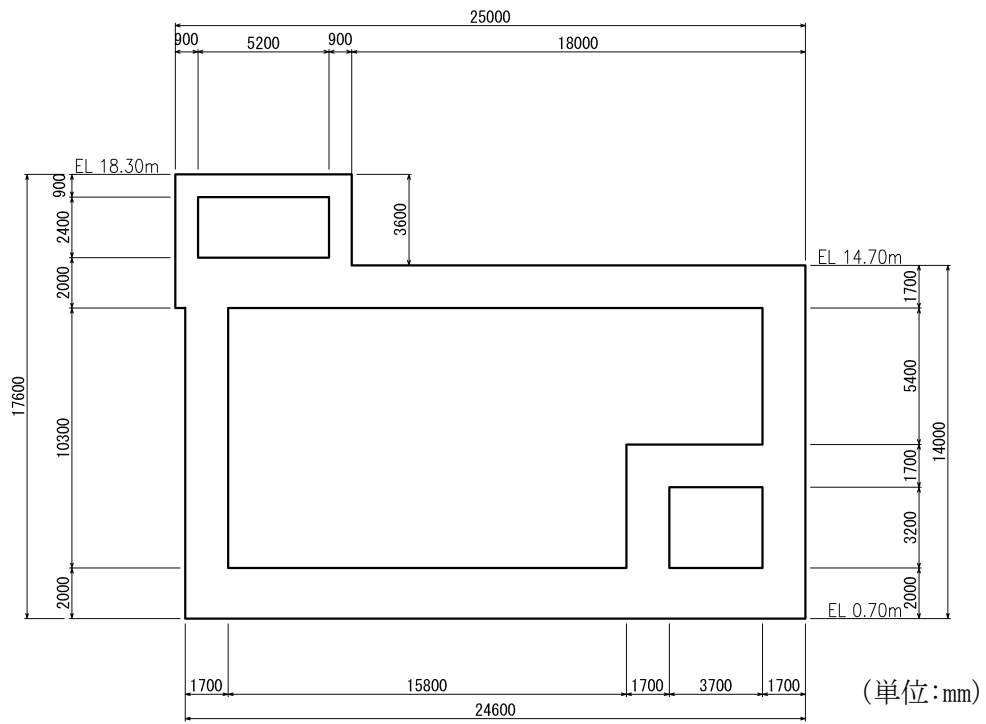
第 1 ベントフィルタ格納槽 断面図 (C-C 断面)
